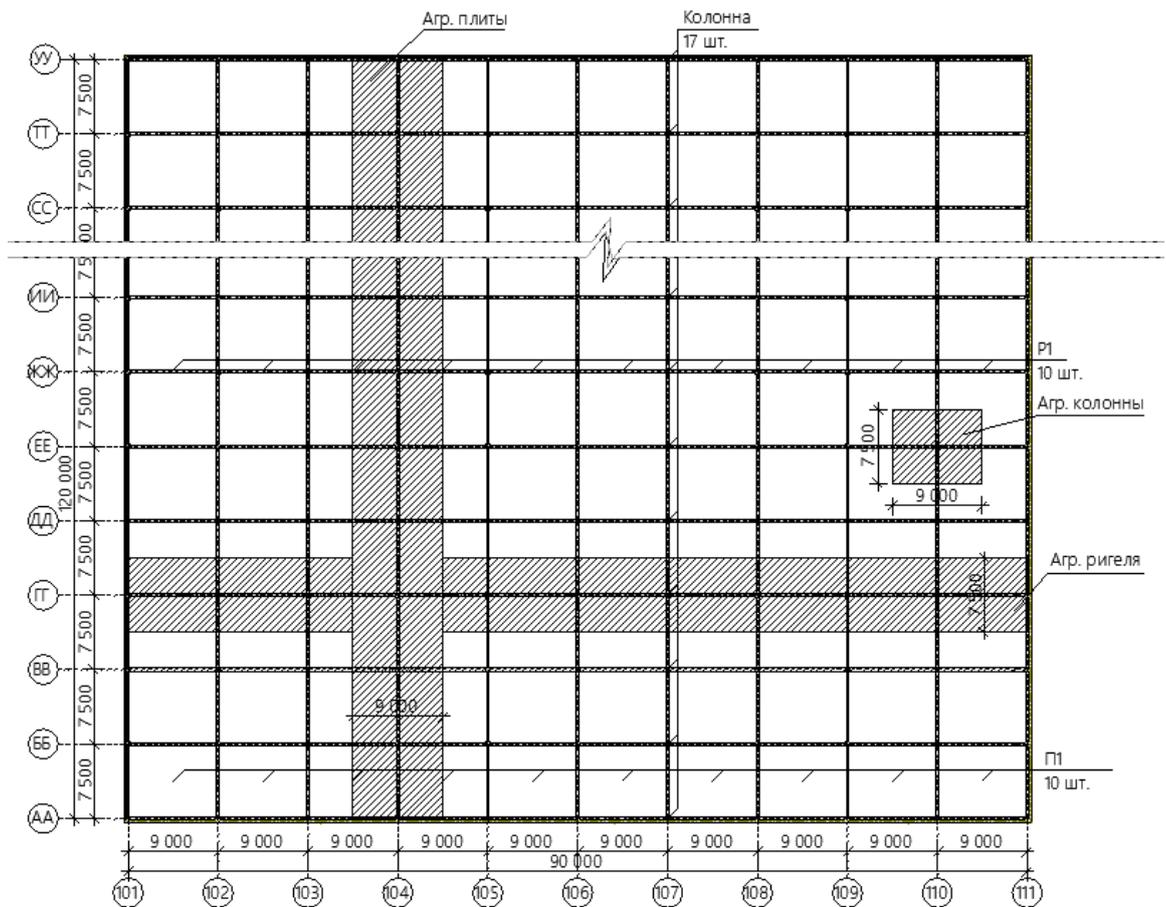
Компонировочная схема монолитного перекрытия
